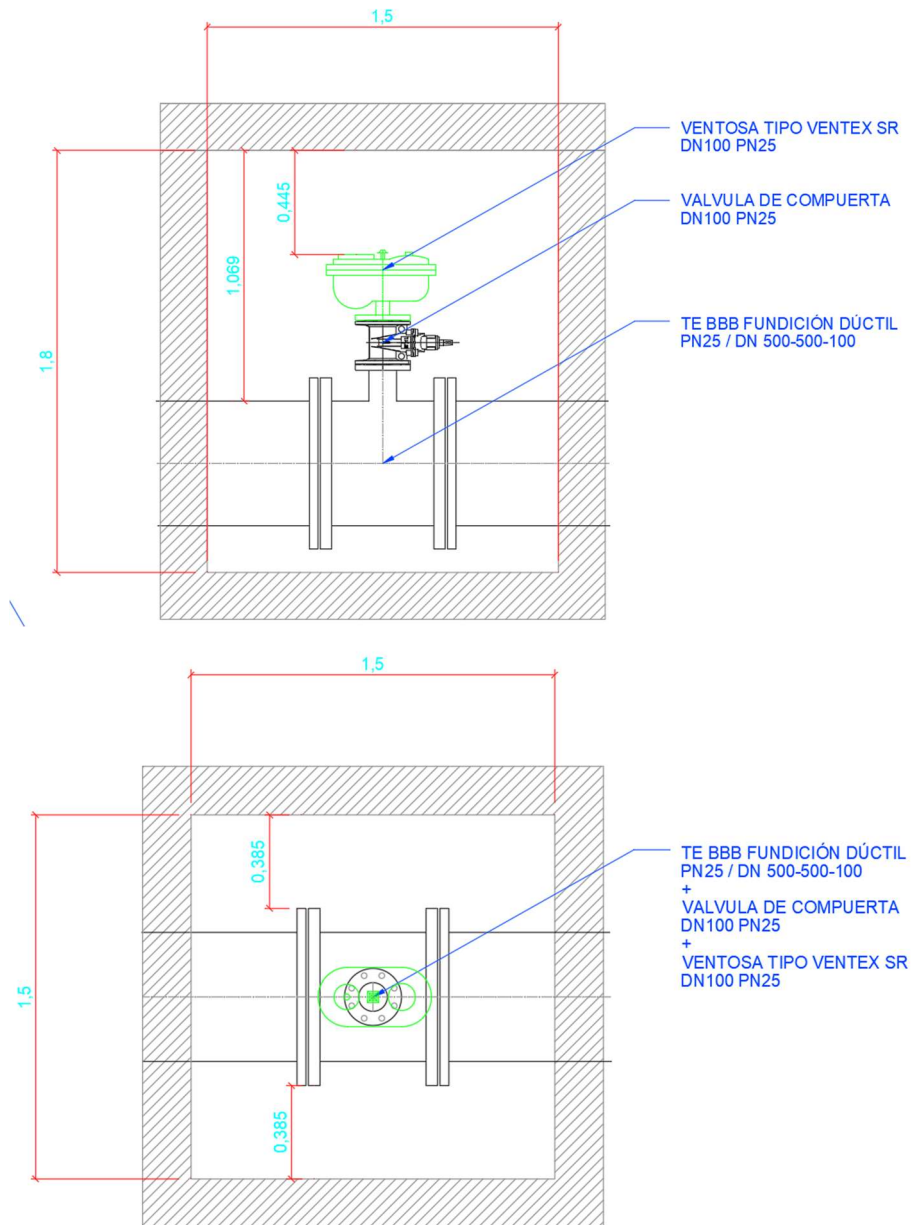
Alzado y planta de la arqueta para instalación de ventosas. Fuente: Elaboración propia
